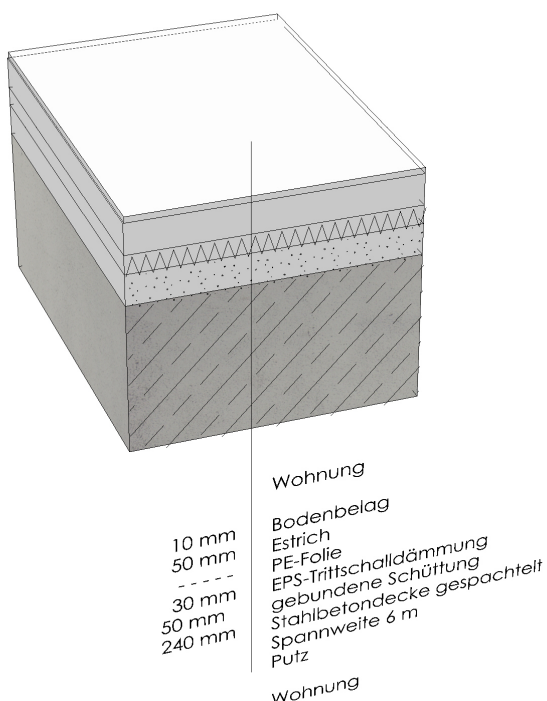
Aufbau einer Geschoßdecke (auf Grundlage von (76))
